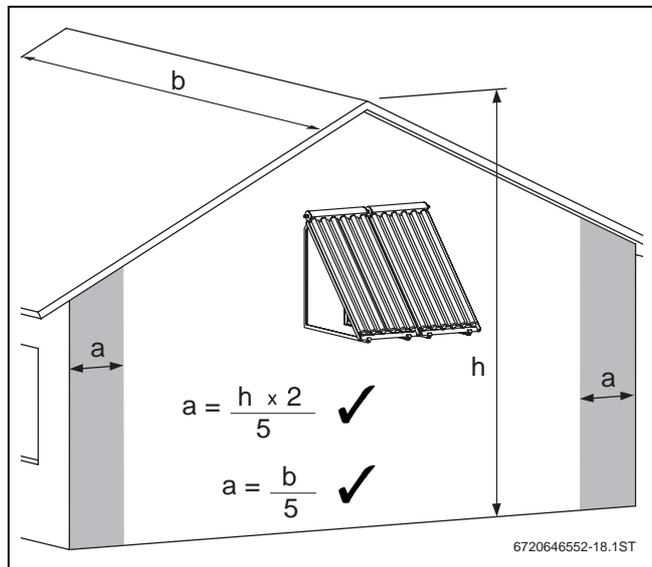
Distanza minima dal perimetro laterale (misura a) con montaggio alla facciata; applicare una formula, possibili entrambe
